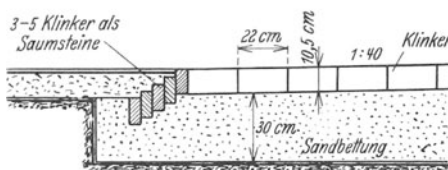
Abschluß des Klinkerpflasters durch versenkte Klinkerreihen.
